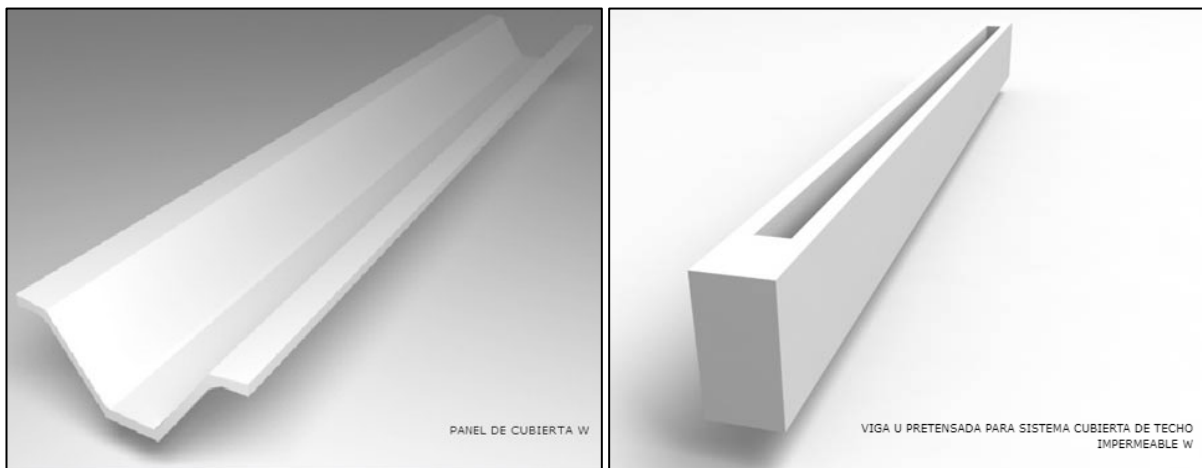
Sistema de cubierta impermeable. Fuente: Pretensa Estructuras.
